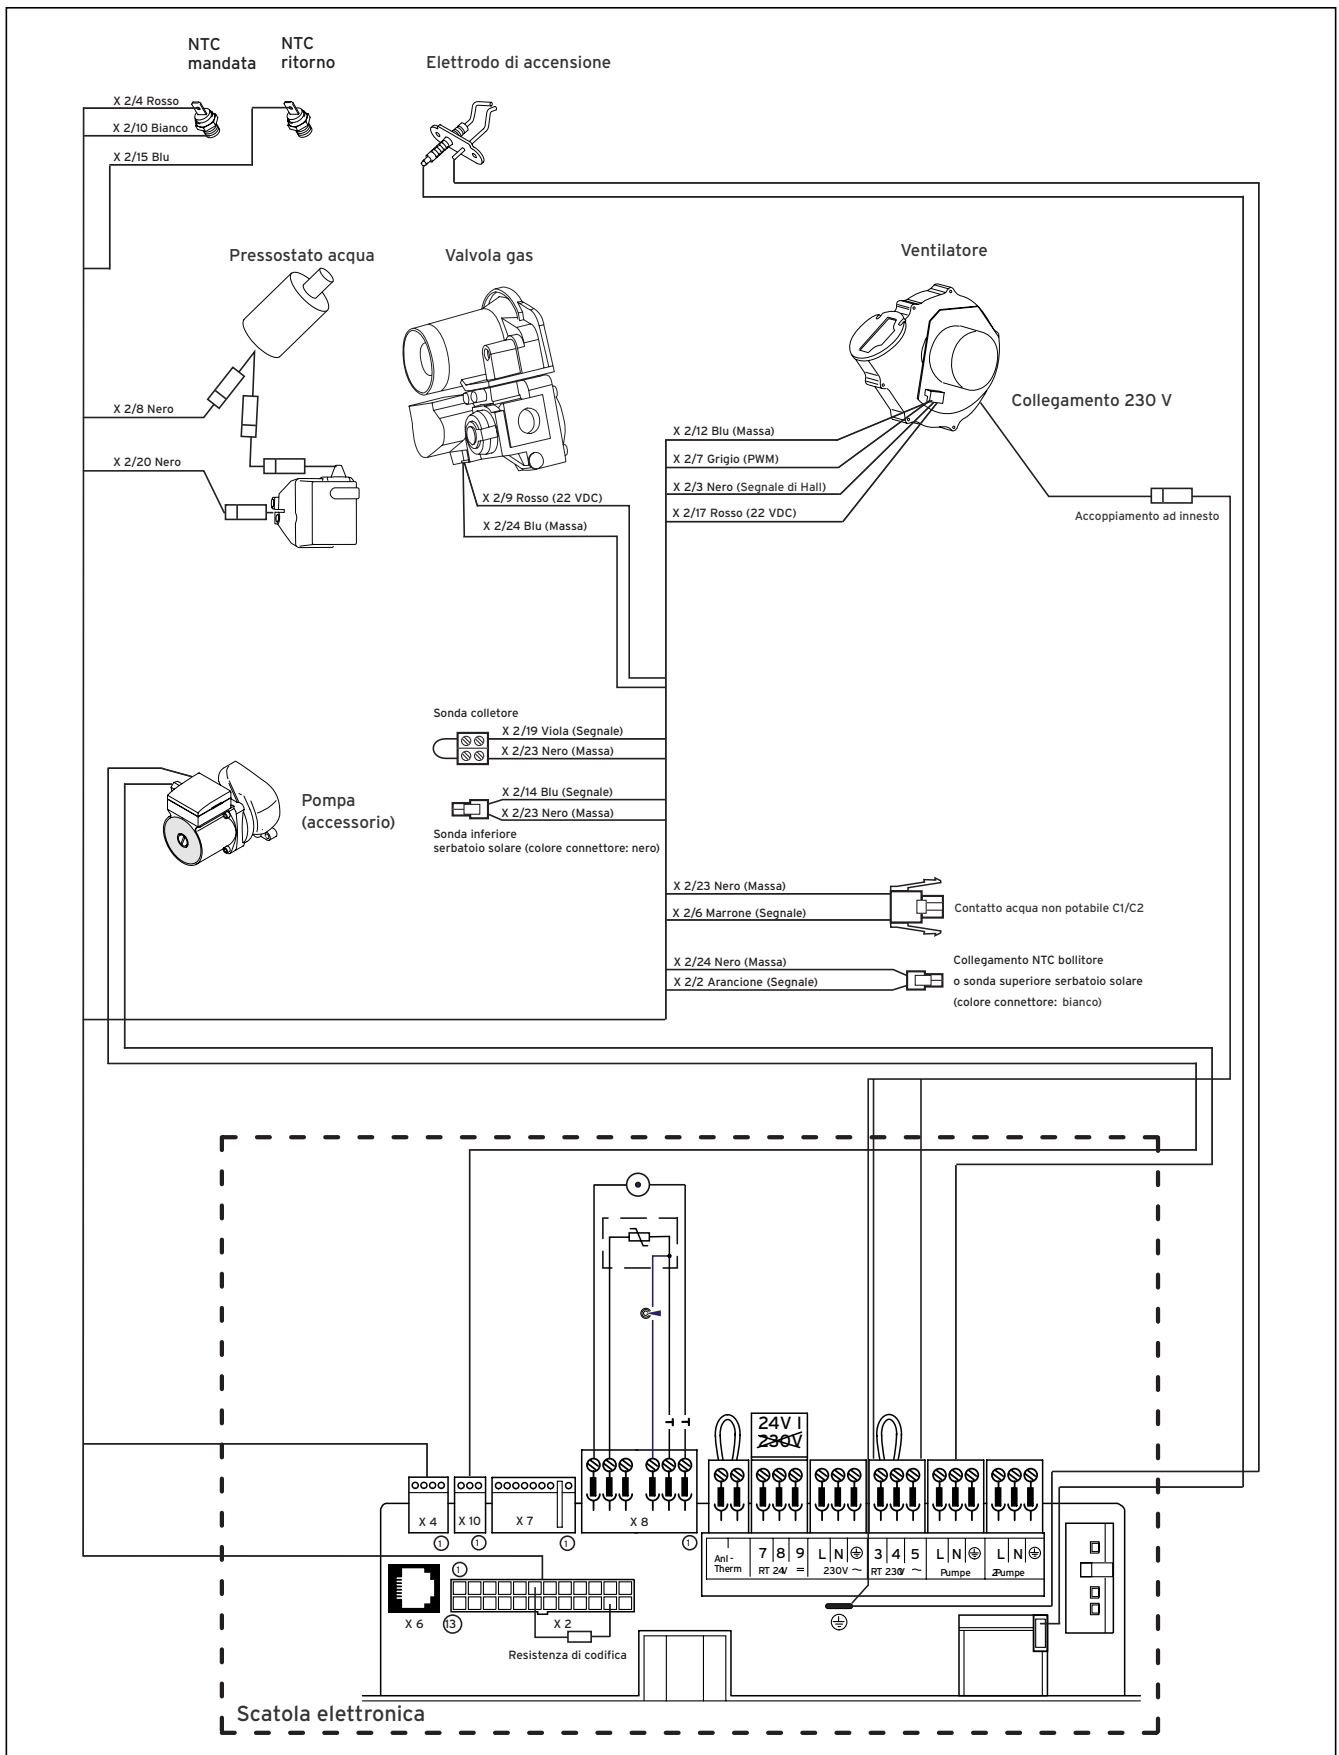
Cablaggio ecoBLOCK VM 656-E
